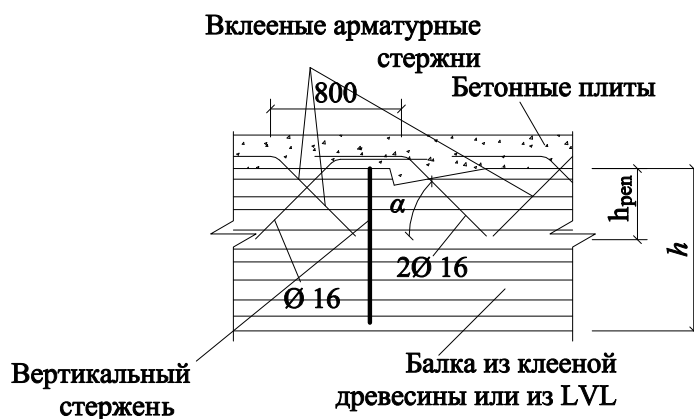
Схема соединения бетонной плиты проезжей части с деревянной балкой посредством вклеенных арматурных стержней
